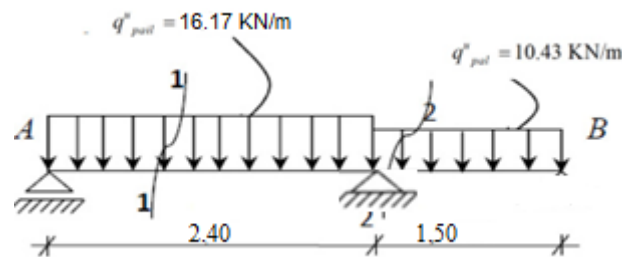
Schéma statique de la charge appliquée sur la Paillasse et le palier (ELU)
